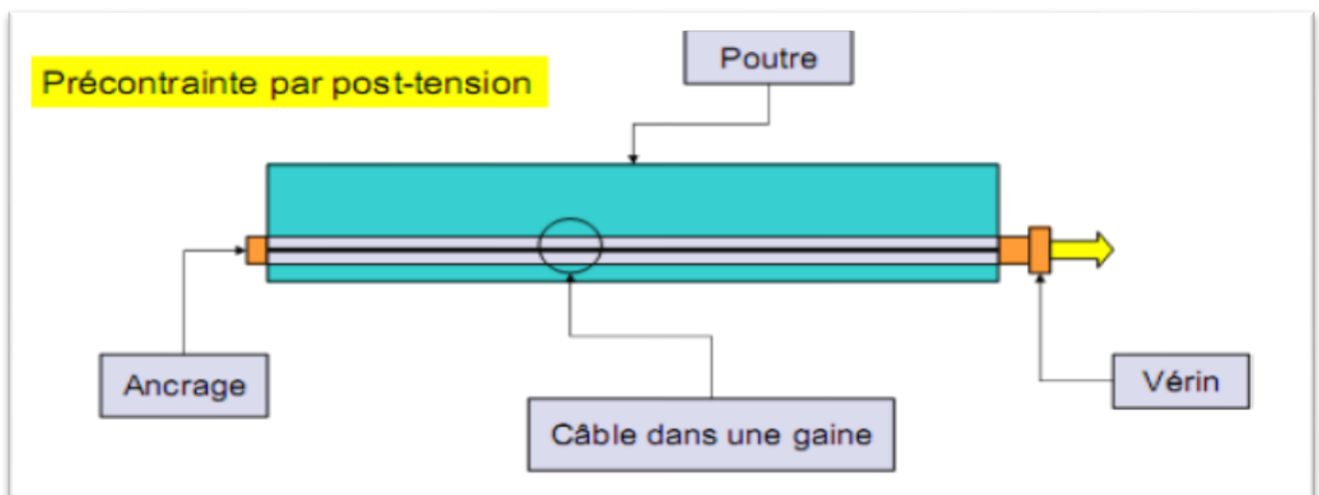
coupe longitudinale d'une poutre en béton précontraint par post tension [4]
